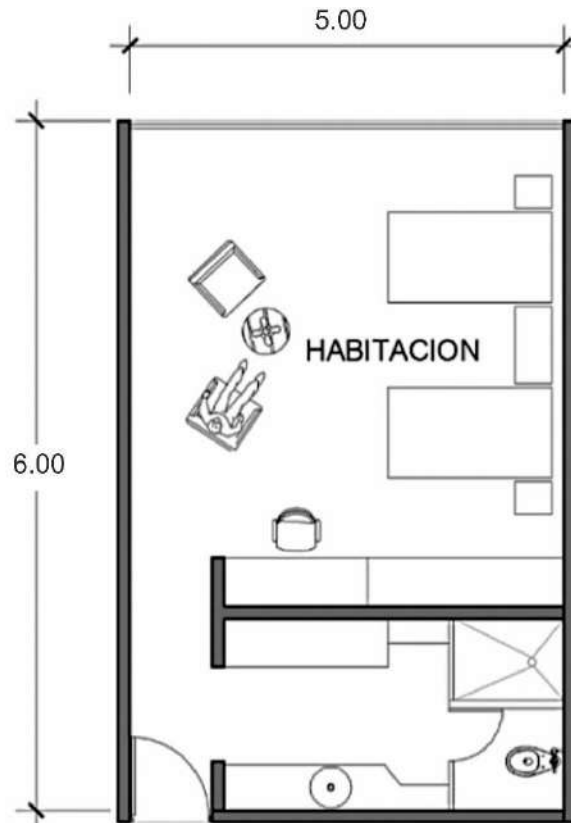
Planta de habitación Hospedaje<sup>281</sup>
